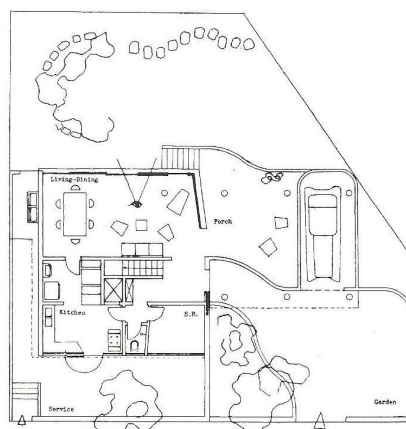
OSCAR NIEMEYER, 1940. RESIDENCIA CAVALCANTI, PLANTA BAJA. (REF. ON.1940.PG.1943.164a)
